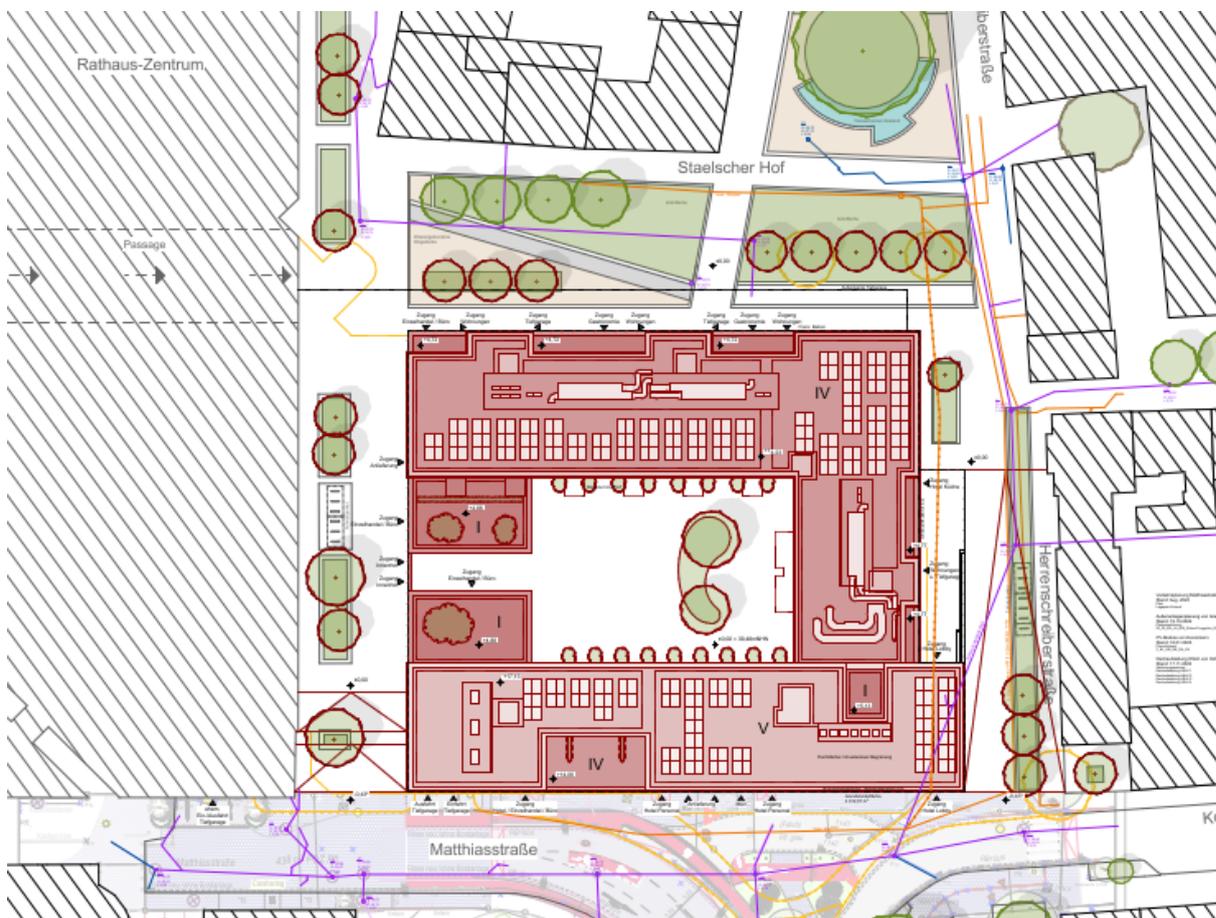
Lageplan, Achterkamp + Möller Architekten, 2024
